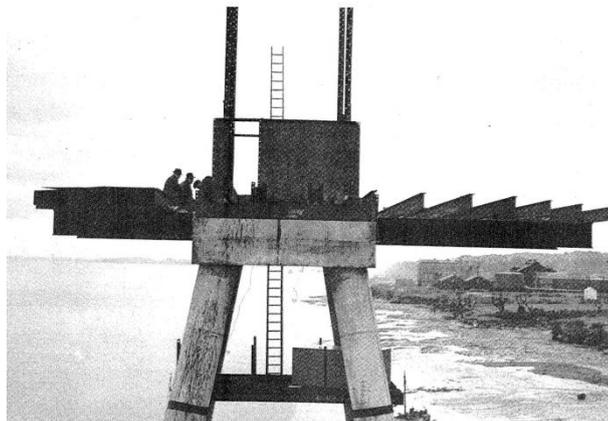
Unterkonstruktion aus Stahlbeton mit einbetonierten Stahlträgern
